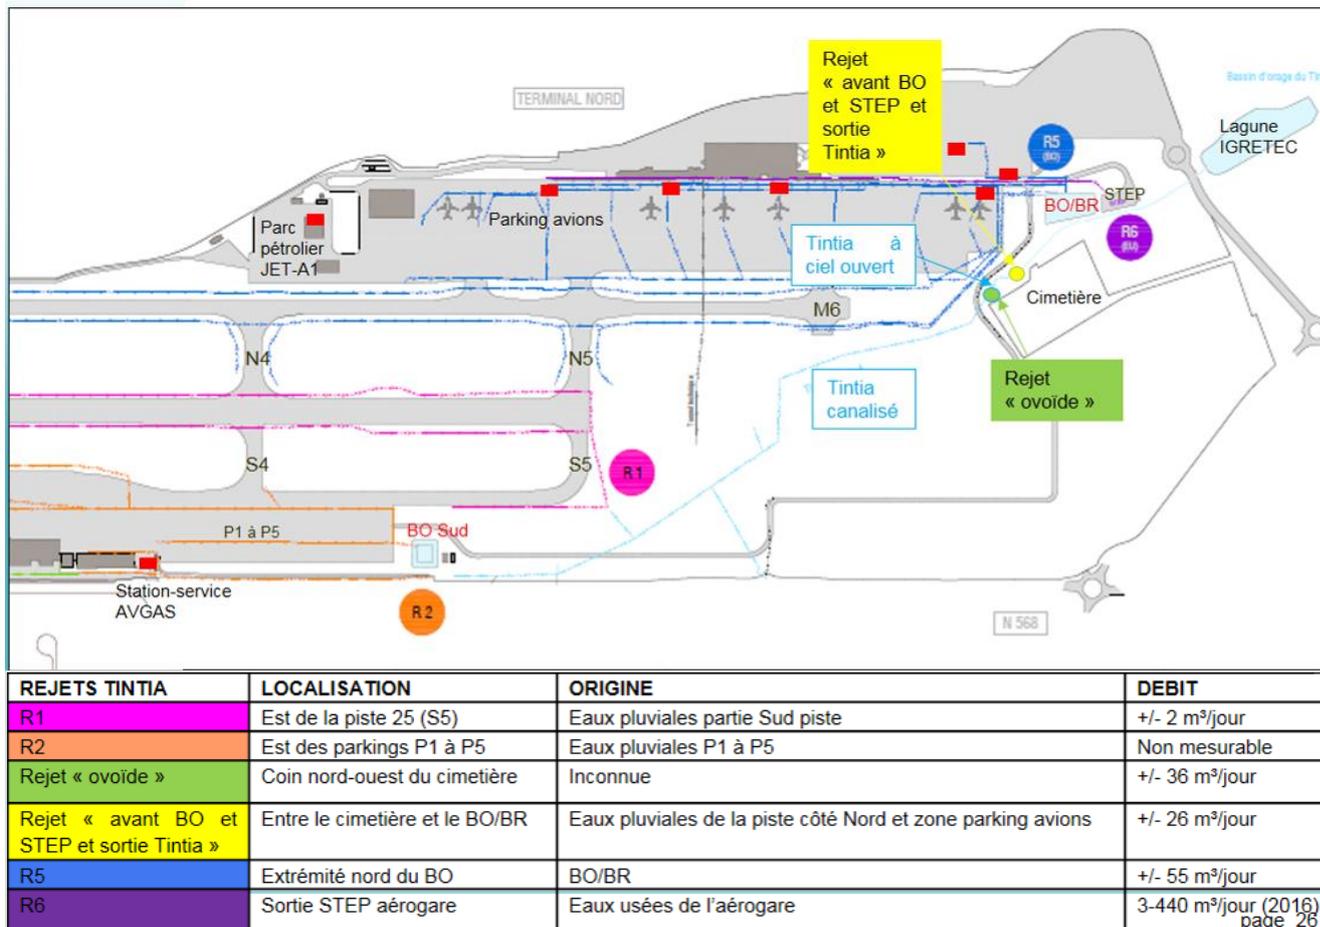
Plan d'égouttage de la partie Est du site et rejets dans le Tintia
